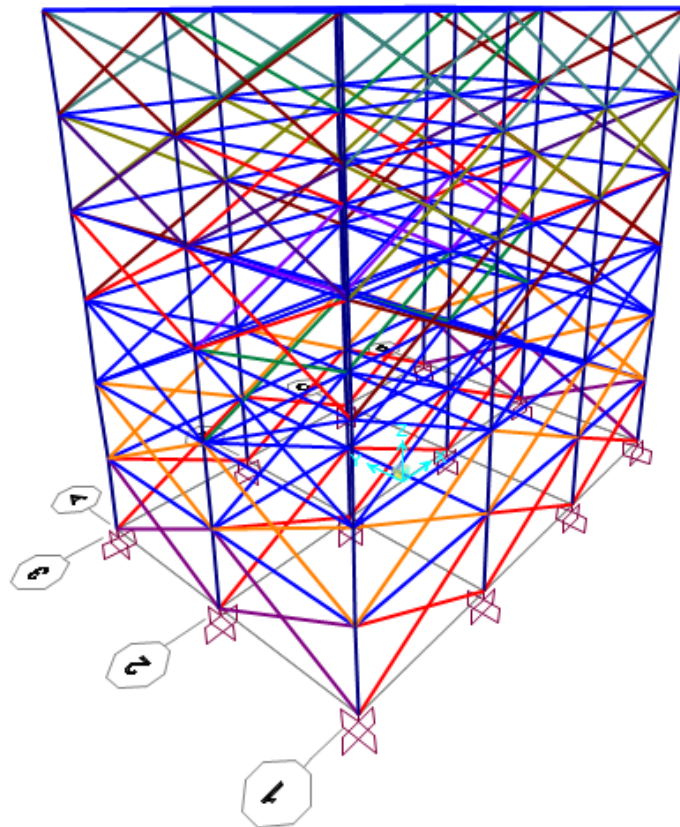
Vista tridimensional de la tipología 1 en SAP2000, con vigas, columnas y muros.
